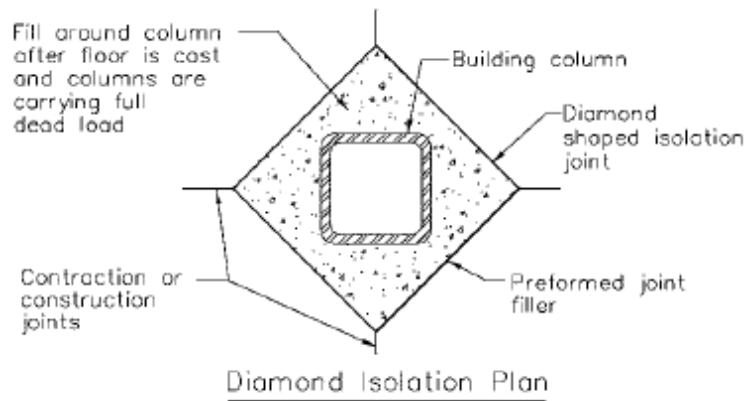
Colocación junta de aislamiento (ACI 360, 2016)
